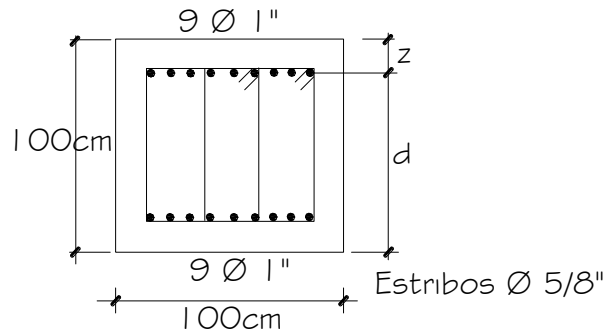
Sección transversal de la viga travesaño propuesta
